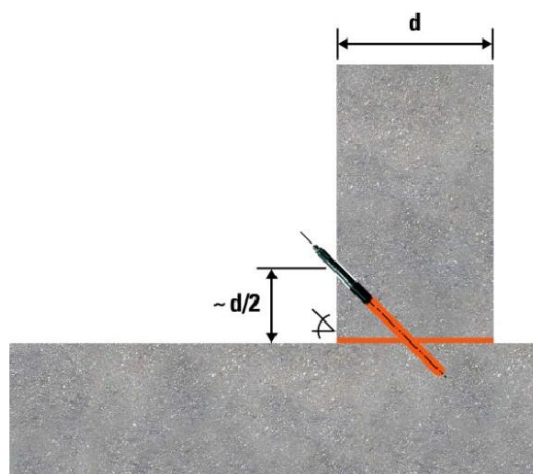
Injeção para impermeabilização de juntas de betonagem (Sotecnisol, 2009).
